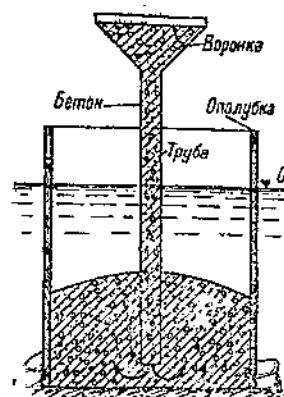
Схема укладки бетона по методу вертикально перемещающейся трубы.
